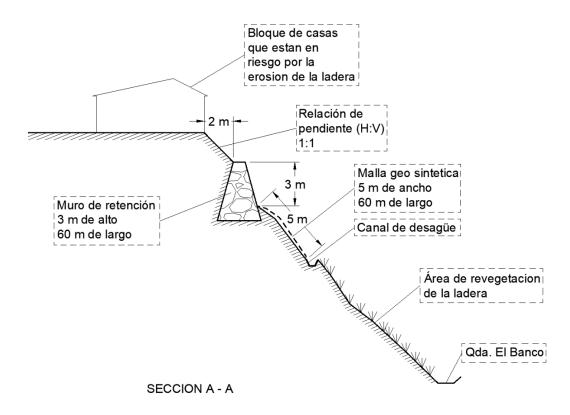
Vista de perfil de las obras (mayo, 2021).
